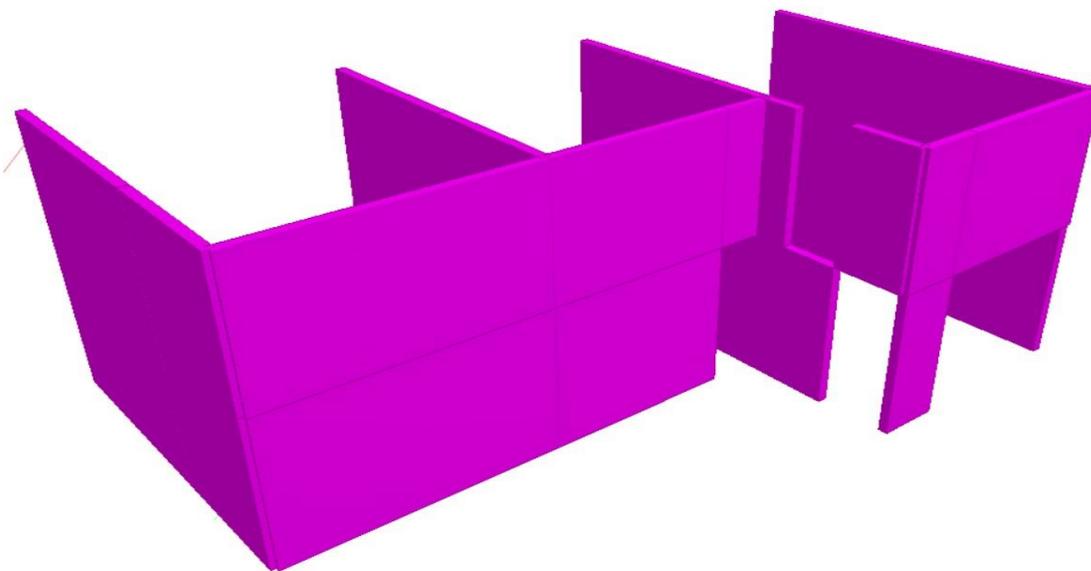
f) Imagen 3D del Modelo estructural de muros de mampostería.
